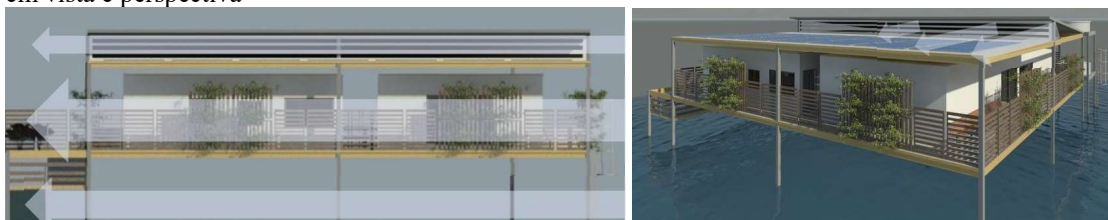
Estudo escolar demonstrando as salas de aula dispostas na fachada leste
